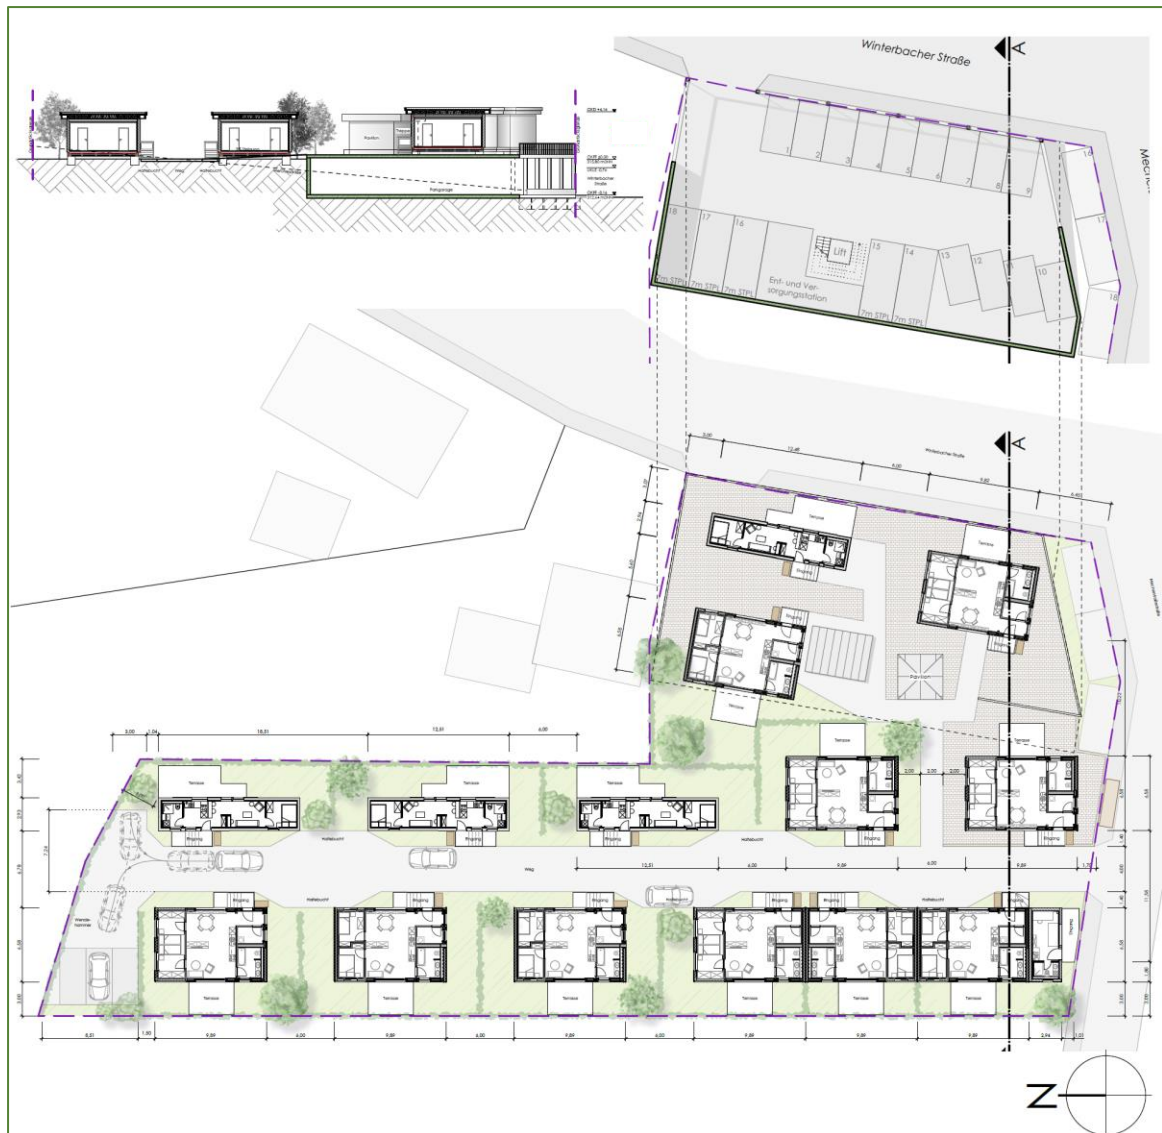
Lageplan (Wohnpark Winterbach Projekt GmbH)
